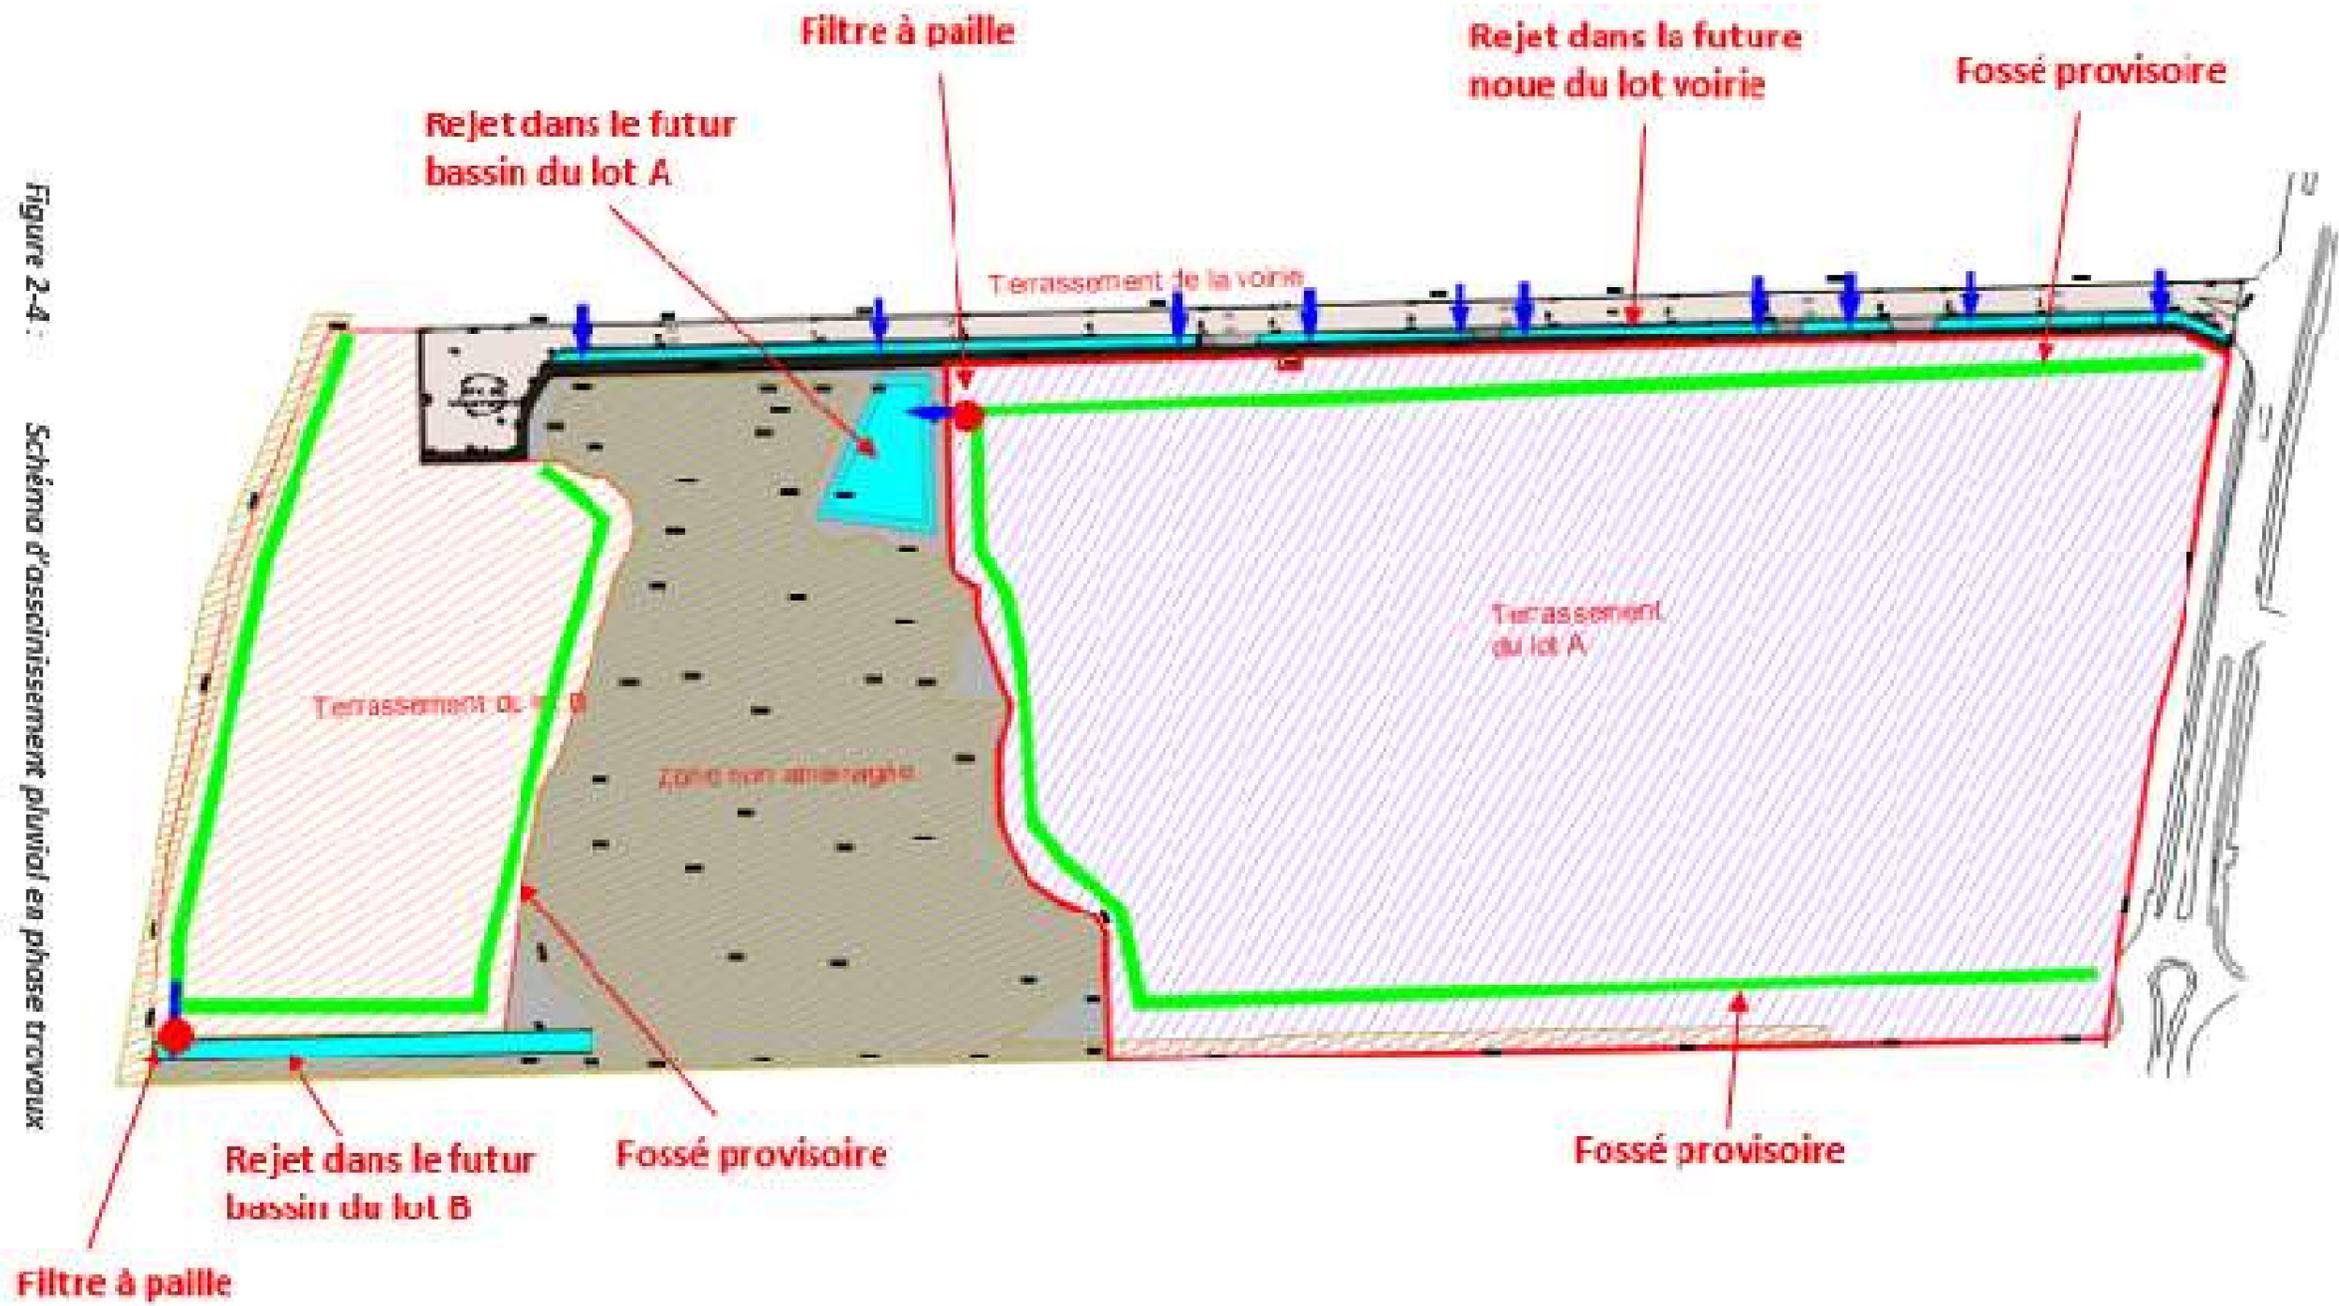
Schéma d'assainissement pluvial en phase travaux
